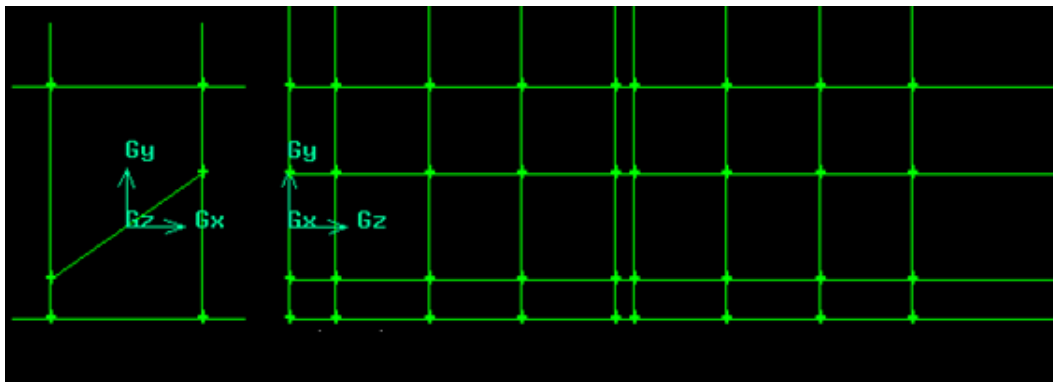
Perfil y alzado de los paneles de la Figura 33.
